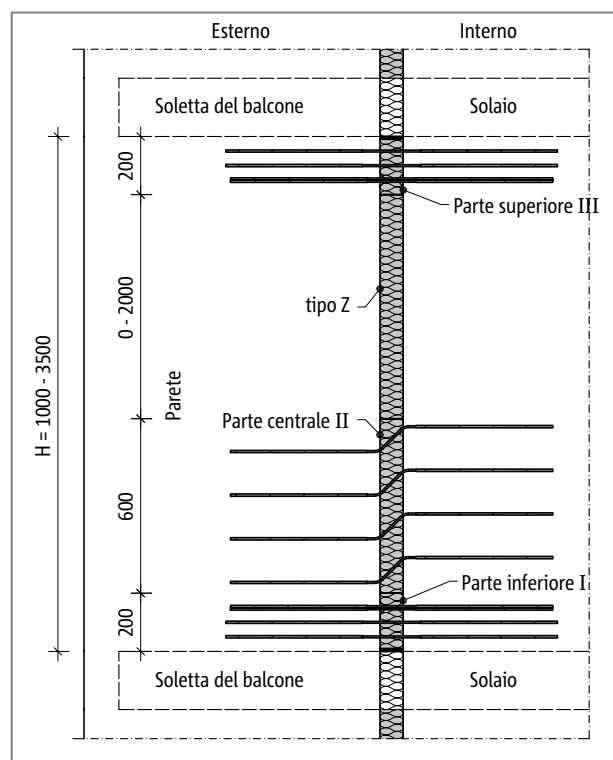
Schöck Isokorb® T tipo WL-M1-V1: balcone con lastre delle pareti portanti e termoisolate
